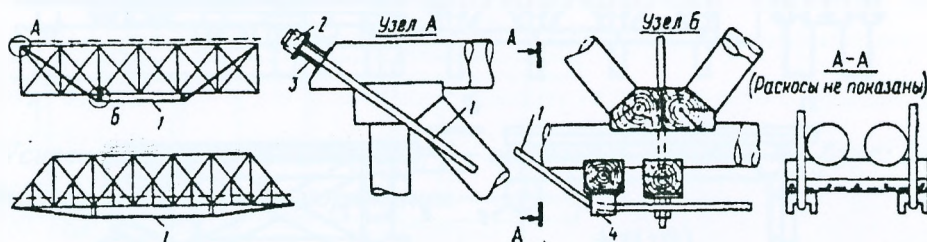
Усиление ферм Гау-Журавского: 1 – шпренгель; 2 – анкерная колодка; 3 – опорная балка; 4 – стальная подушка.
